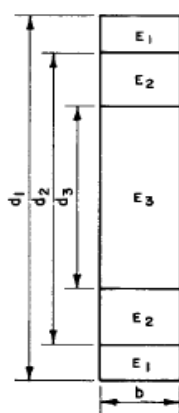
Viga dividida em 3 zonas de rigidez (Anexo 4 da ASTM D 3737-5 (ASTM, 2005)).
